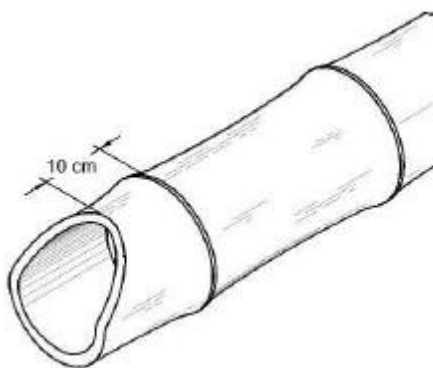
Corte boca de pescado en elemento de Guadua.
